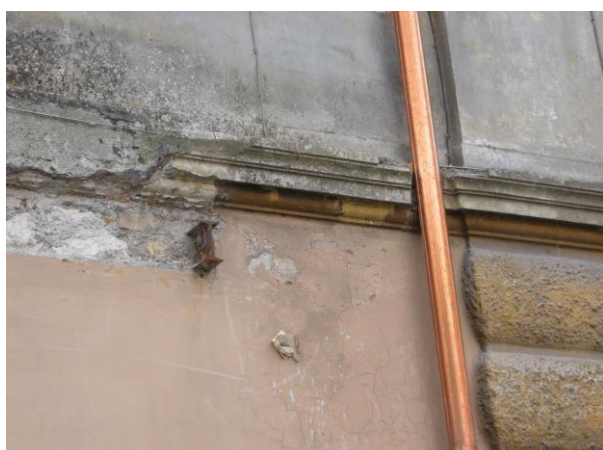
Facciata nord – mancanza dell'apparato (fascia marcapiano)
